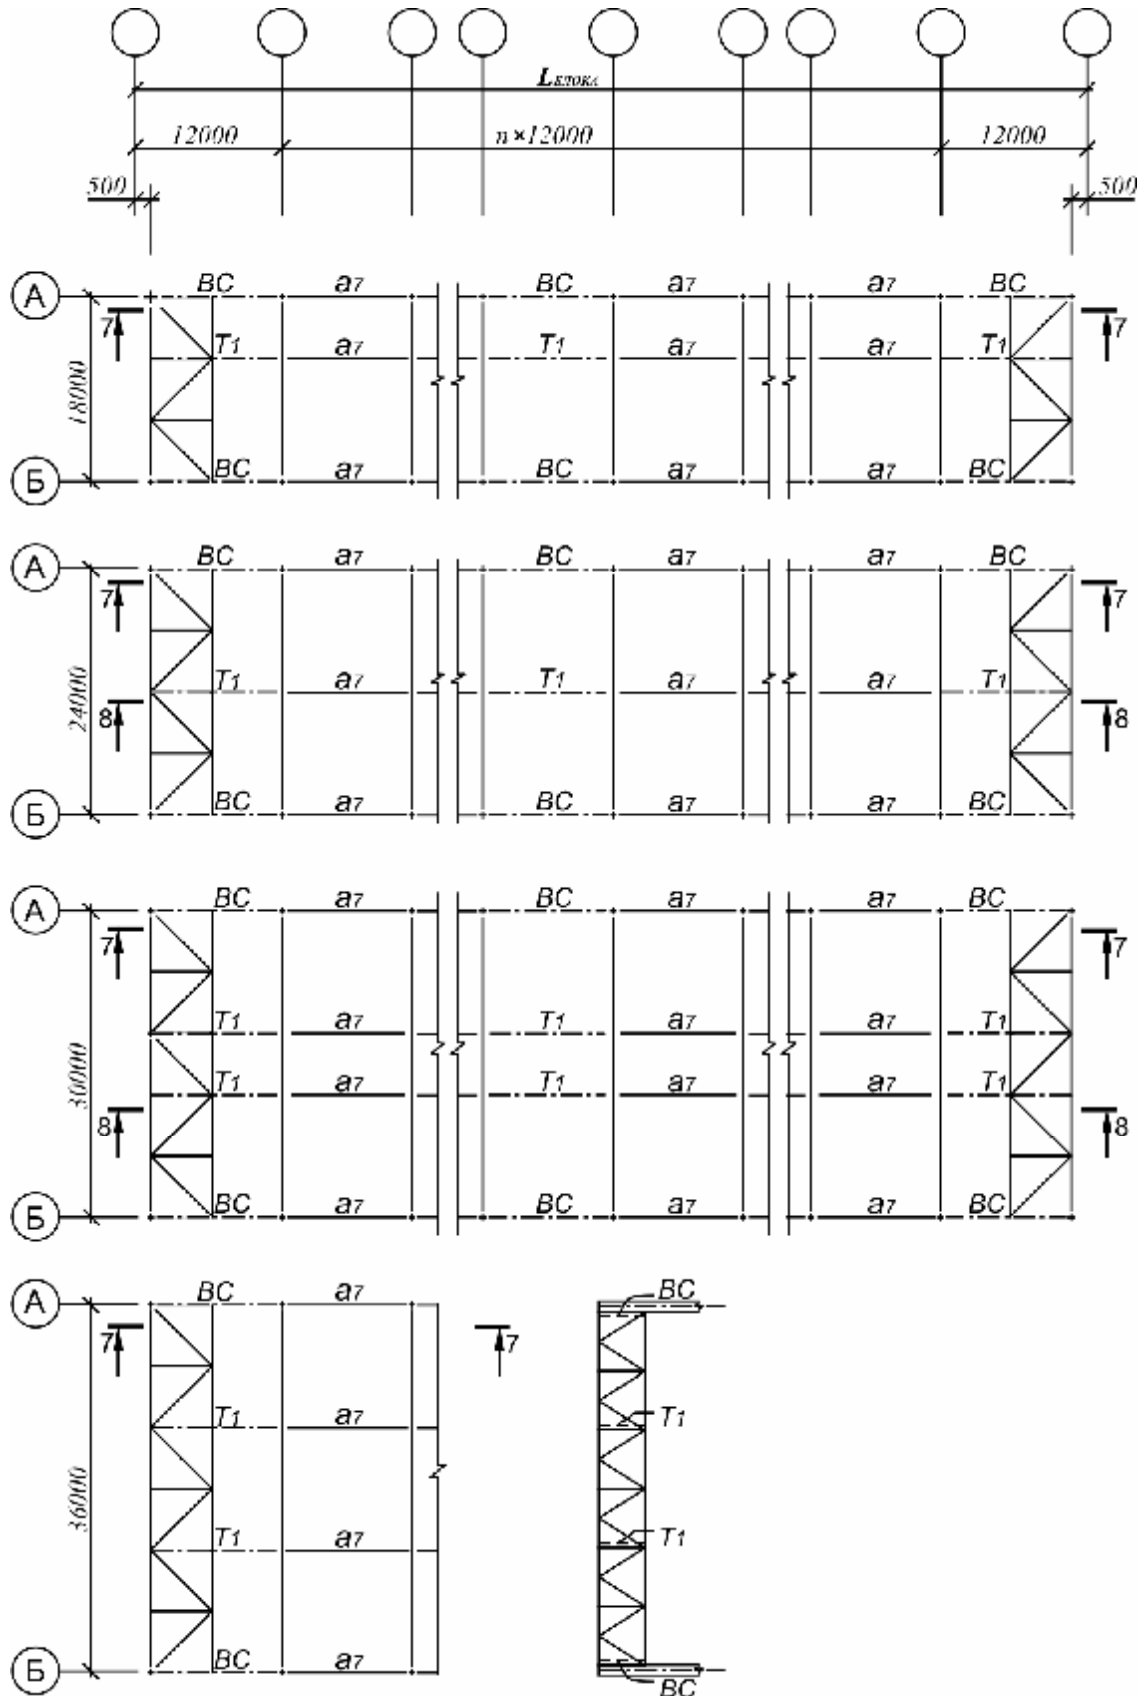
Безпрогонне покриття, крок ферм 12 м
